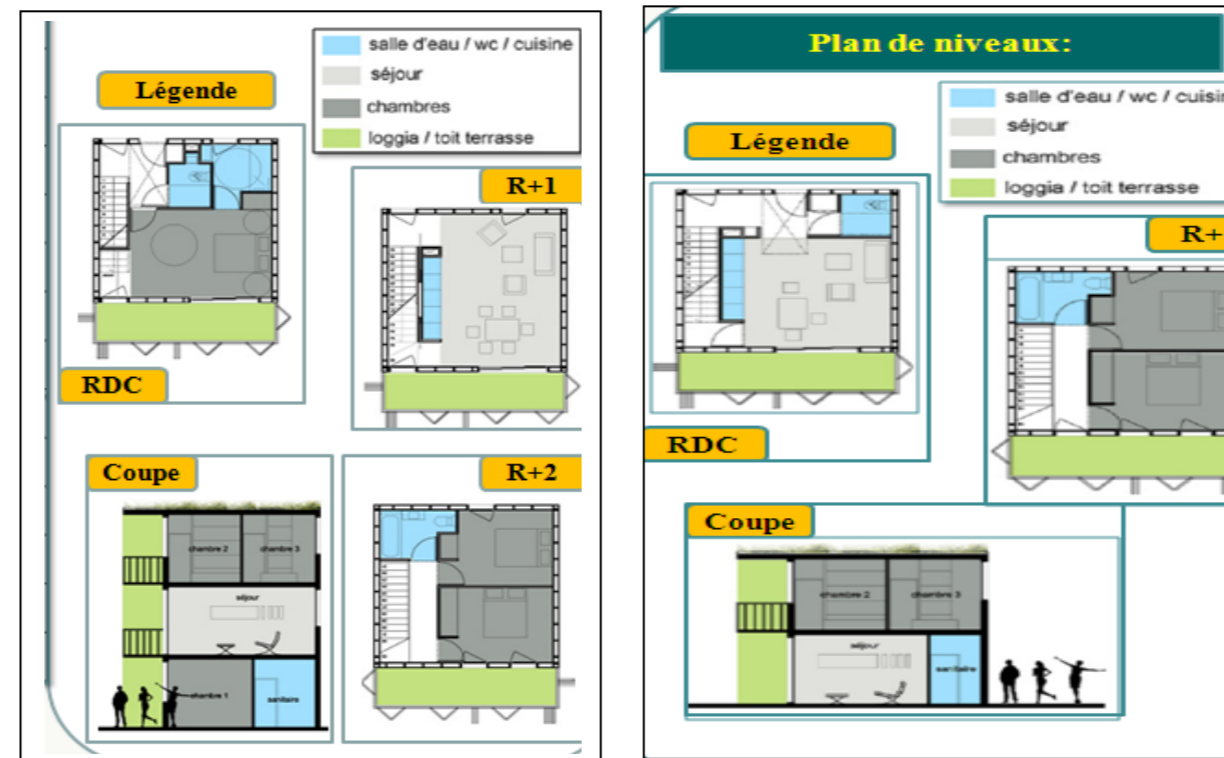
Plan RDC ; R+1 ; coupe d'une unité du logement Individuel Groupé
